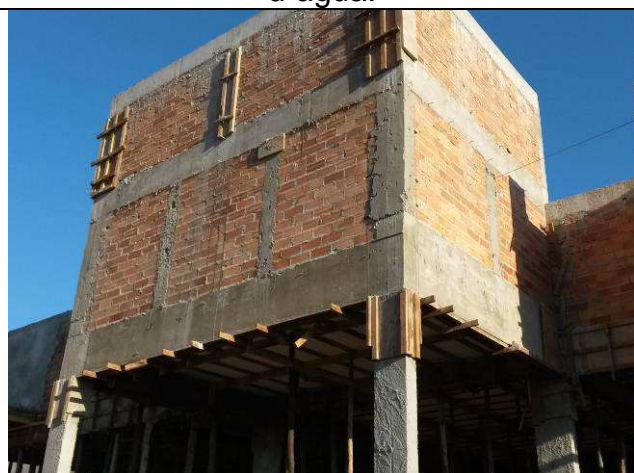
C: Pilares, vigas e lajes da caixa d'água.
